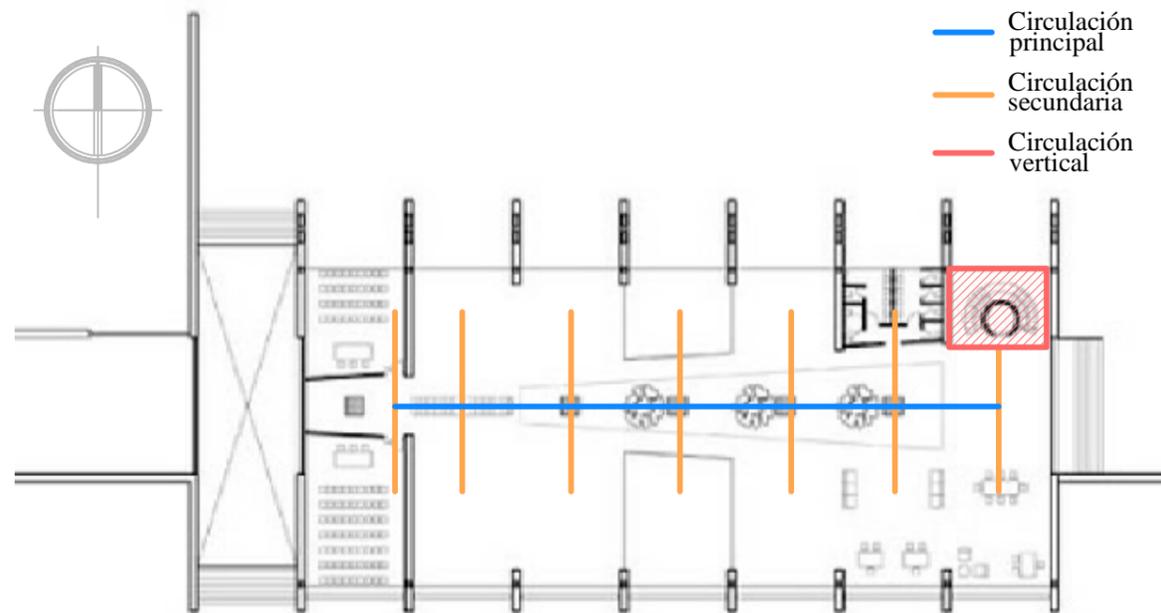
Configuración de circulación en planta tipo (planta alta y baja)
